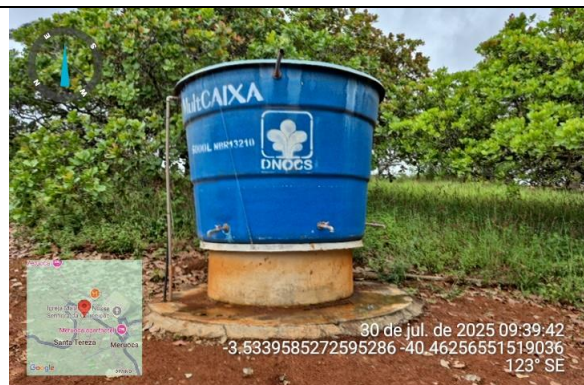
Meruoca/CE, 30.07.2025 – Poço instalado.
